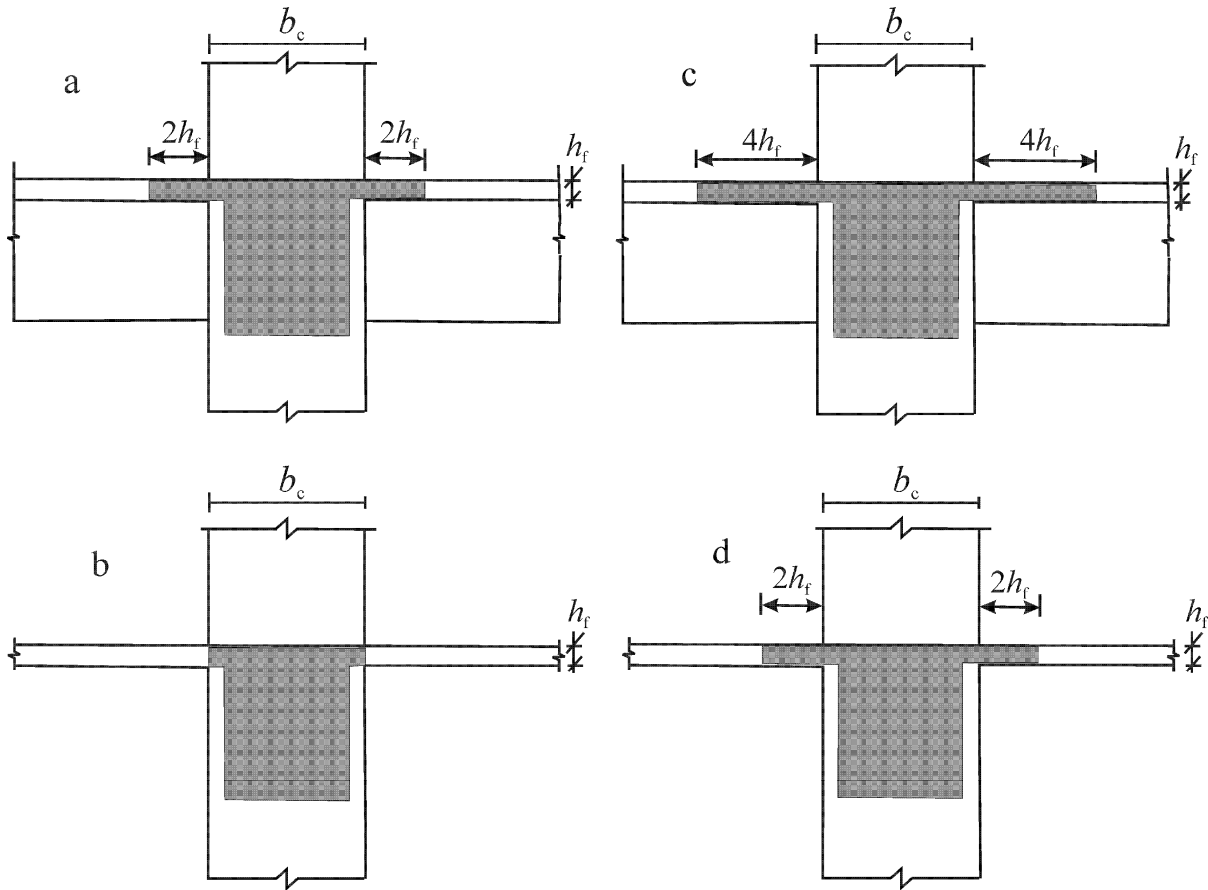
Largeurs participantes de dalle : a et b : à un poteau extérieur.
